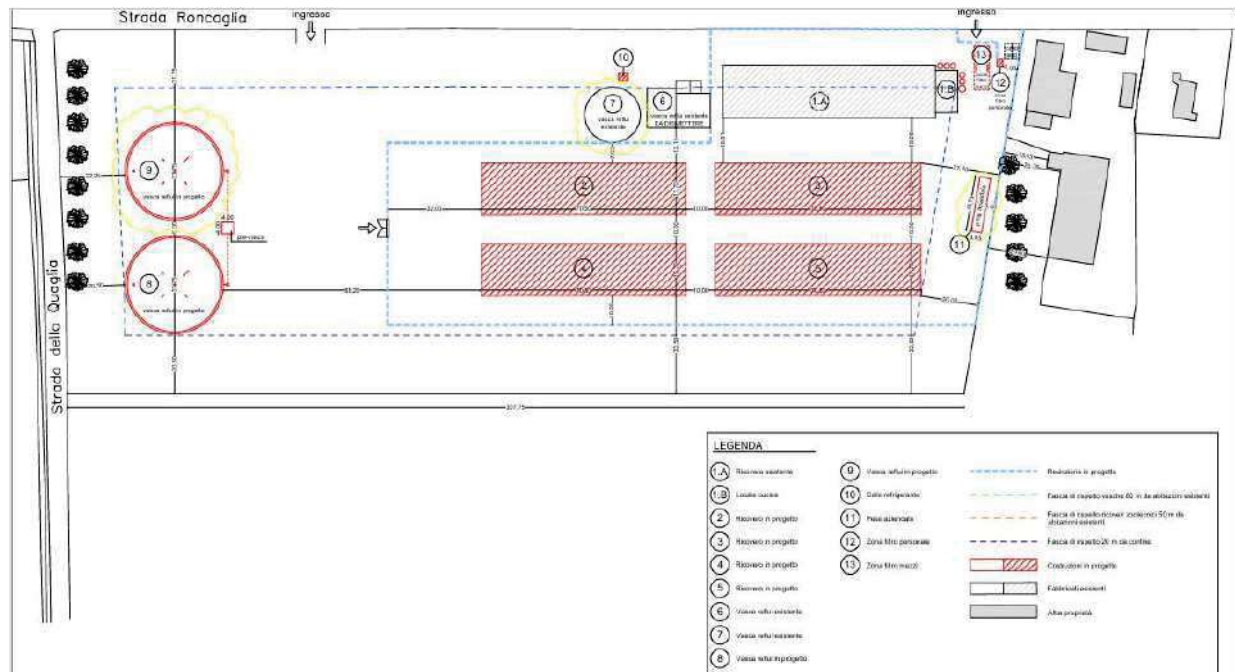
Estratto planimetria, tratta dal progetto dello Studio CAVALLI (Allegato 2), dell'ampliamento dell'insediamento zootecnico e della dislocazione dei nuovi edifici (n. 4 ricoveri zootecnici da destinare all'allevamento di suini all'ingresso, n. 1 vasca per lo stoccaggio dei reflui con dismissione dell'esistente) presenti presso l'area di insediamento dell'allevamento di proprietà di Dellavalle Angelo e Figlio Società Agricola.
